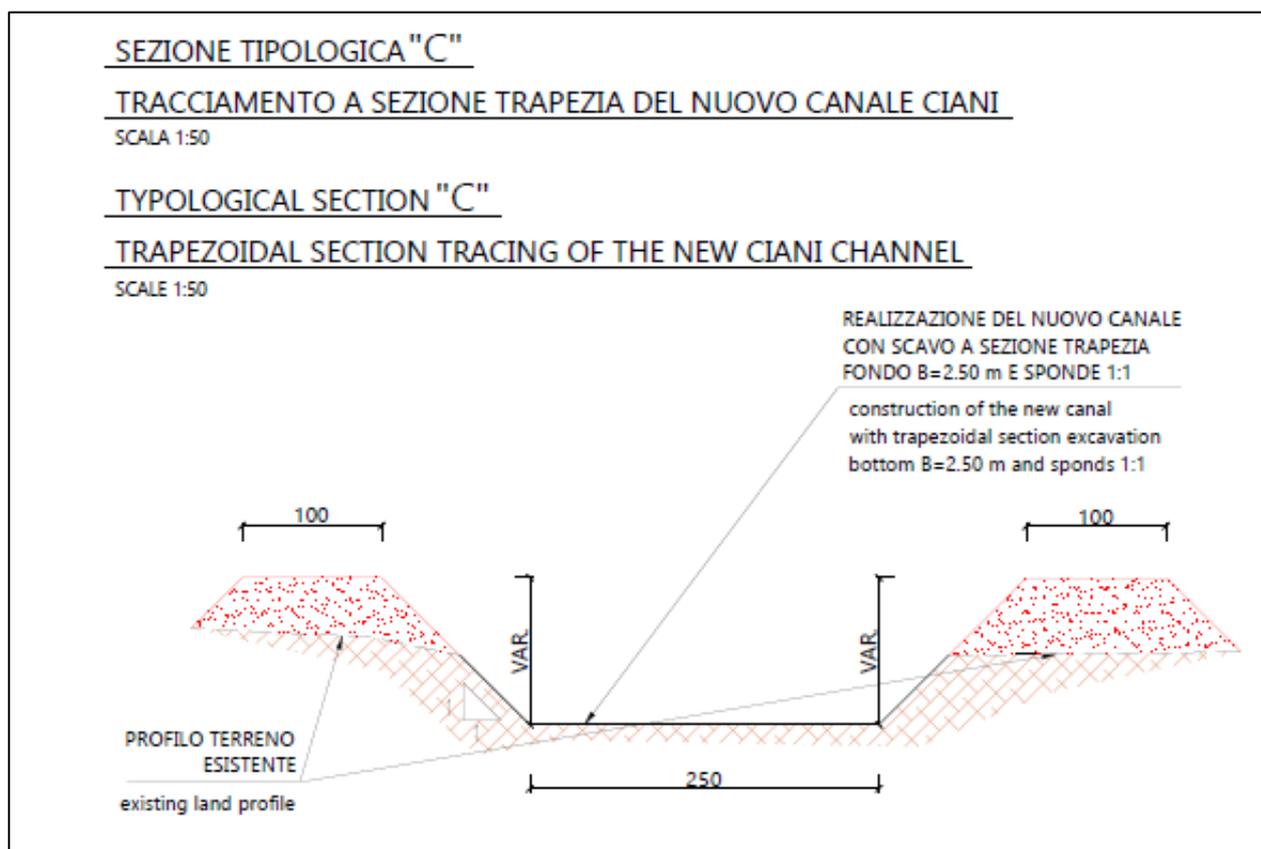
Sezione idraulica tipo del nuovo Cavo Ciani – Estratto Tavola di progetto
